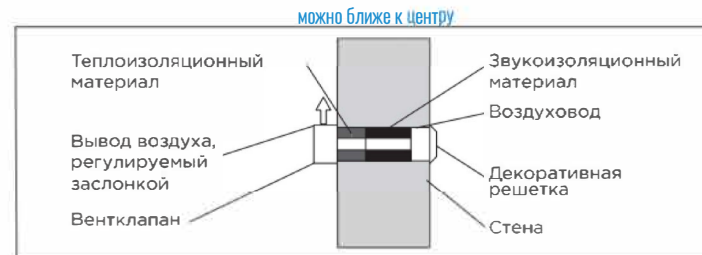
Тип установки 1: вентиляционный клапан устанавливается на наружной стене помещения с внутренней стороны на высоте 2-2,2 м от пола с направлением выхода воздуха вверх
